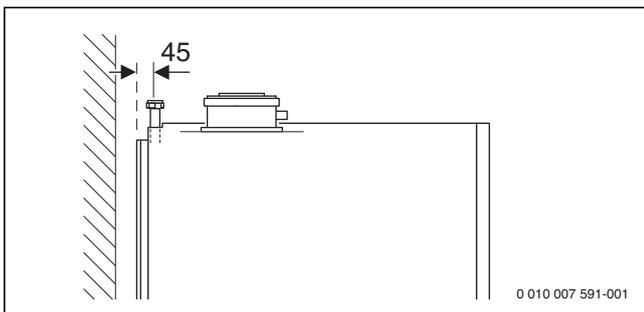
Anschlussmaße des Zubehörs CS 14 (Maße in mm)
